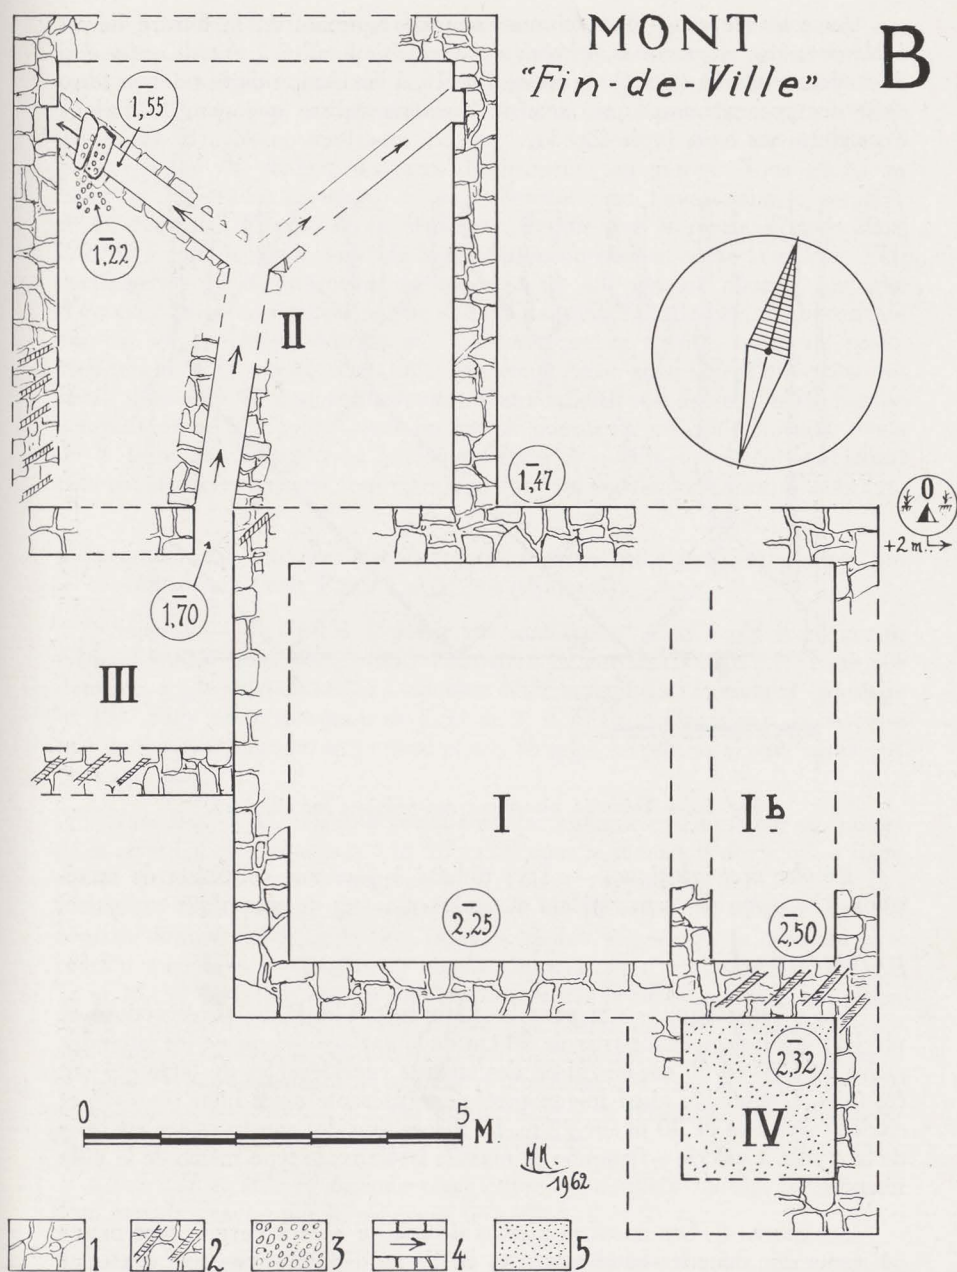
Plan du bâtiment B : 1, mur en pierres de schiste; 2, idem, fort détruit; 3, galets; 4, conduit de chauffage; 5, pavement en béton rouge. (Voir aussi le Plan I en dépliant, en fin d'article).
